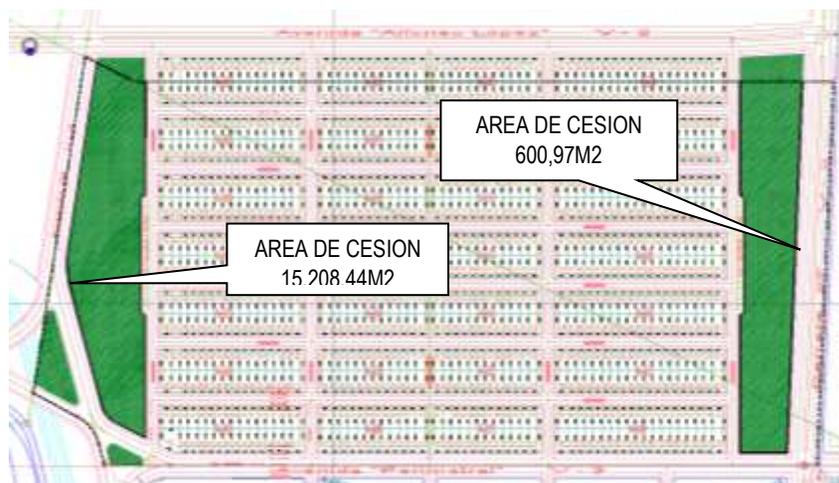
IMAGEN PARCIAL DEL PLANO 01 DE 5 "PLANO GENERAL DE LOTEO"
